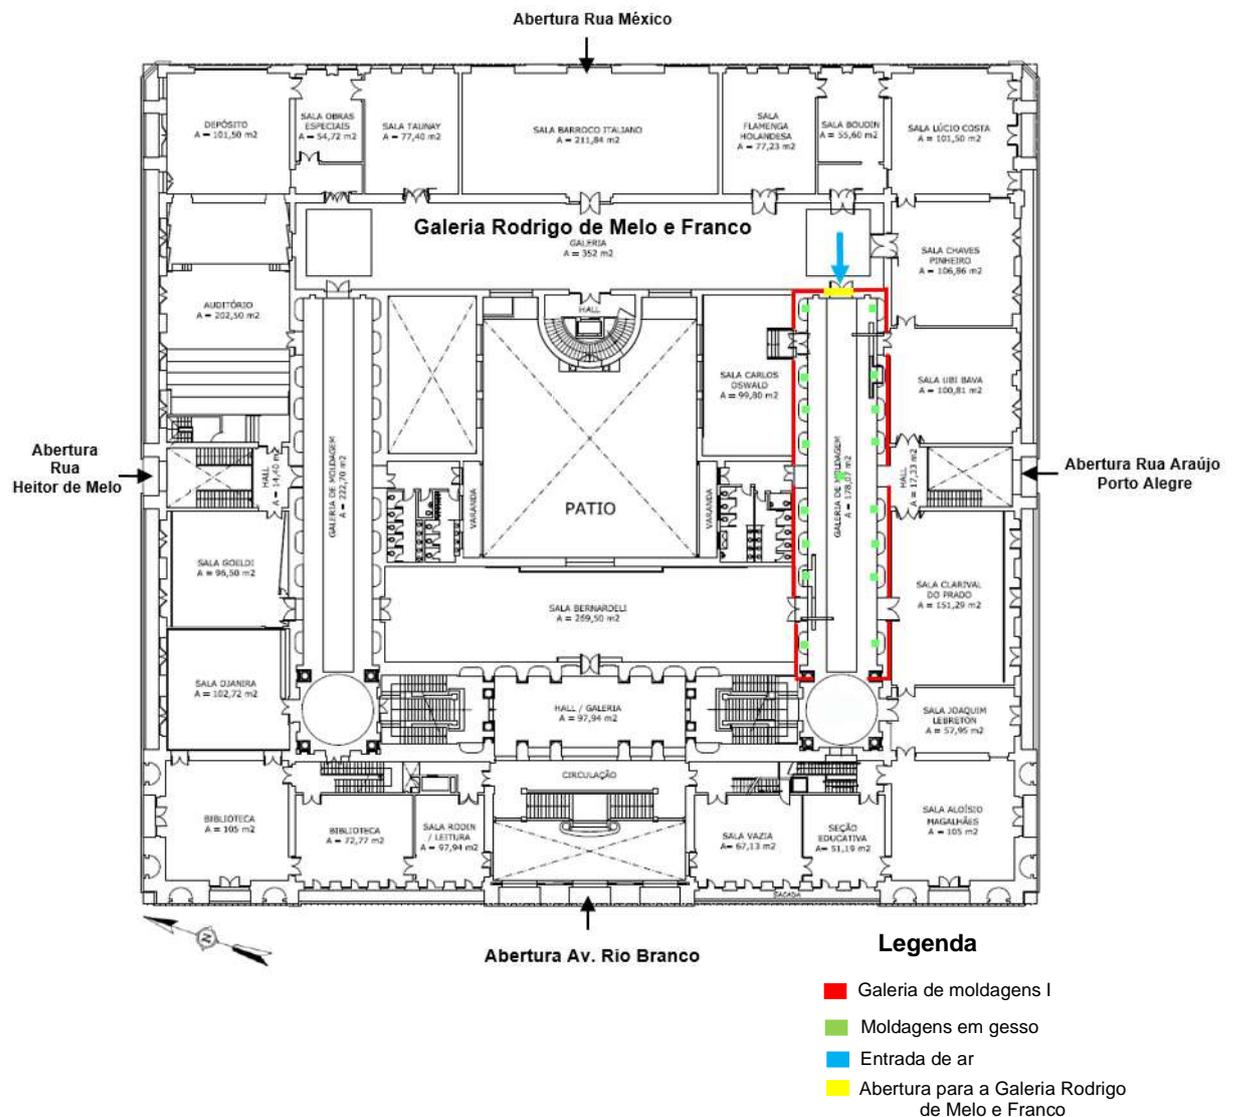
Planta baixa III – 2º Pavimento com inserções para localização Galeria, das aberturas das obras e de fatores ambientais
